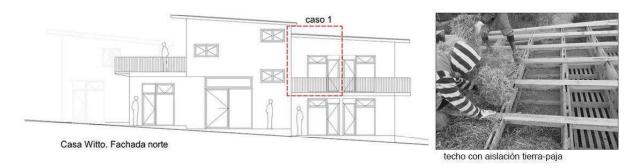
Elevación de fachada norte de casa Alejo y Witto, junto con su respectivo sistema constructivo
